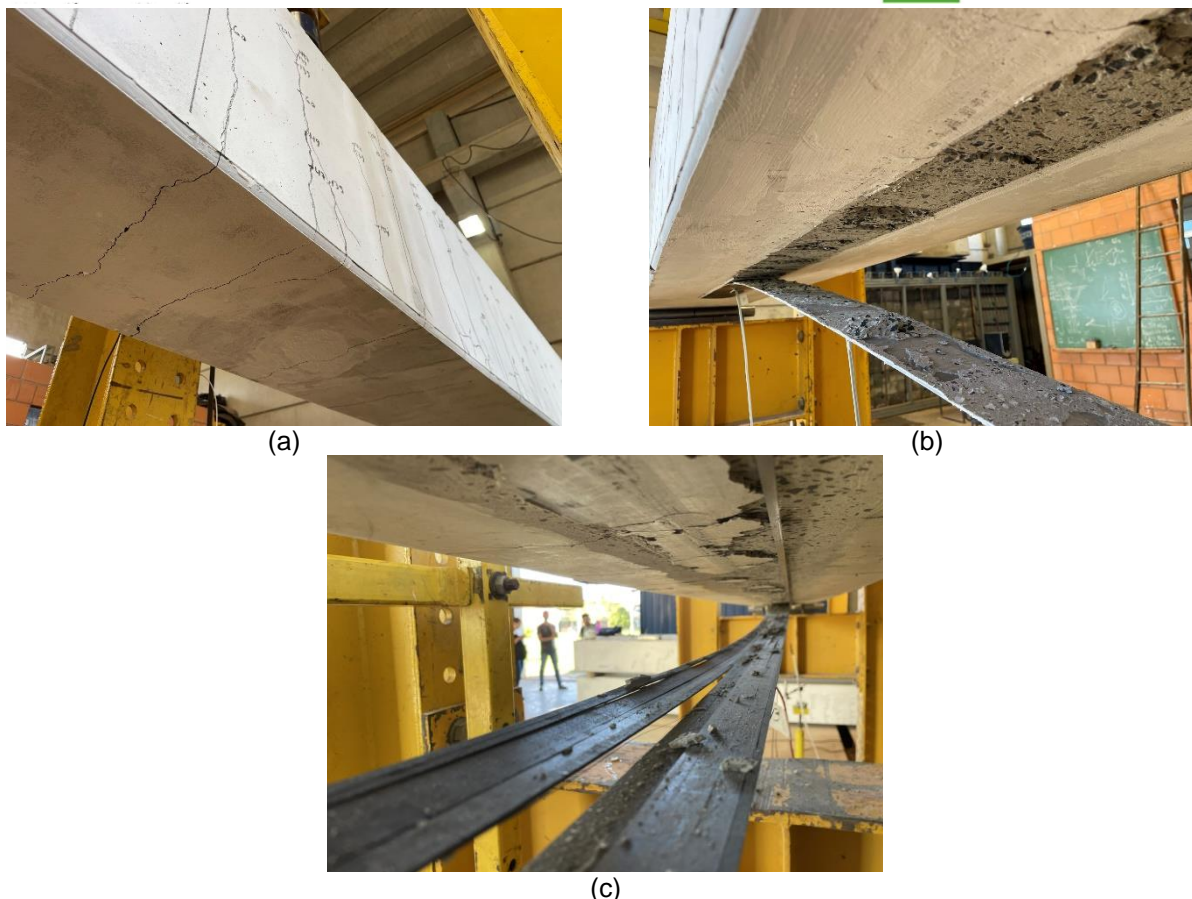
Modo de ruptura das vigas ensaiadas (Autores).
